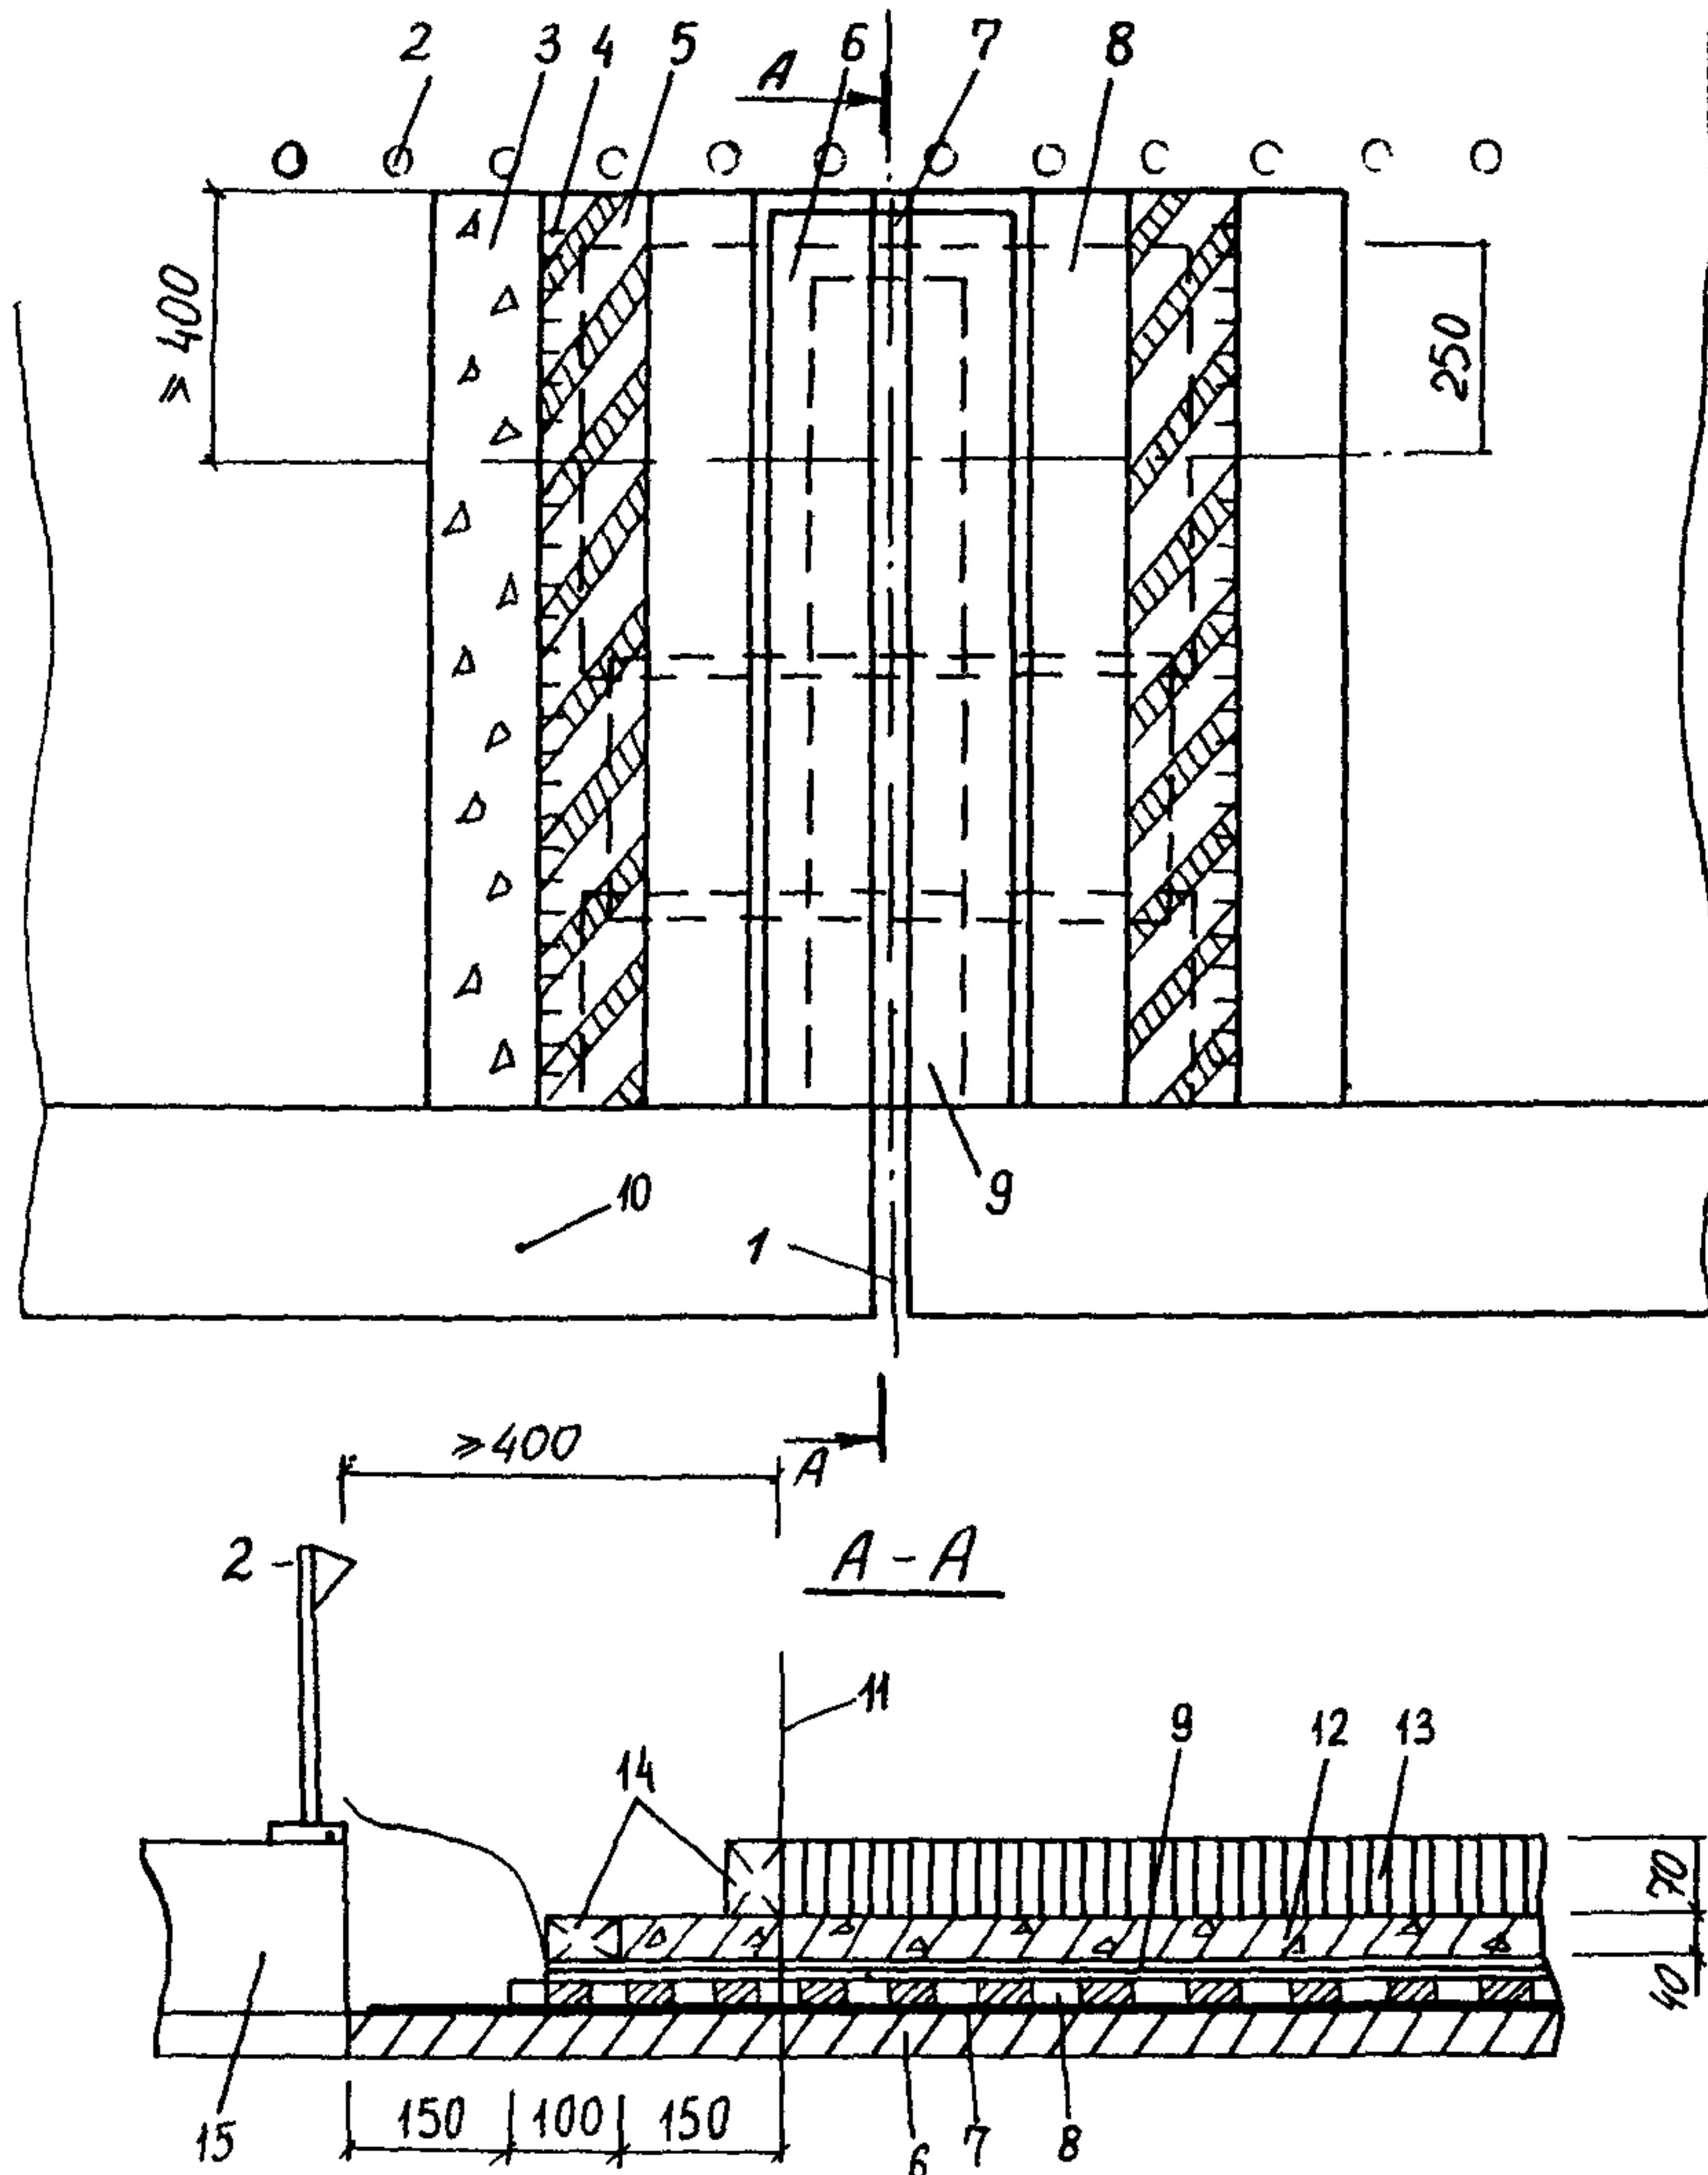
Схема вырубки слоев одежды и их восстановления при реконструкции швов закрытого типа: 1-ось шва; 2-ограждение вырубки; 3-защитный слой; 4-выпуски арматуры; 5-оголенный гидроизоляционный слой; 6-выравнивающий слой; 7-утяжеленный рулонный изоляционный материал; 8-новый слой гидроизоляции; 9-полиэтиленовая пленка; 10-тротуар; 11-ось моста; 12-новый защитный слой; 13-двухслойное асфальтобетонное покрытие; 14-ограничительные доски; 15-участок второй очереди ремонта
